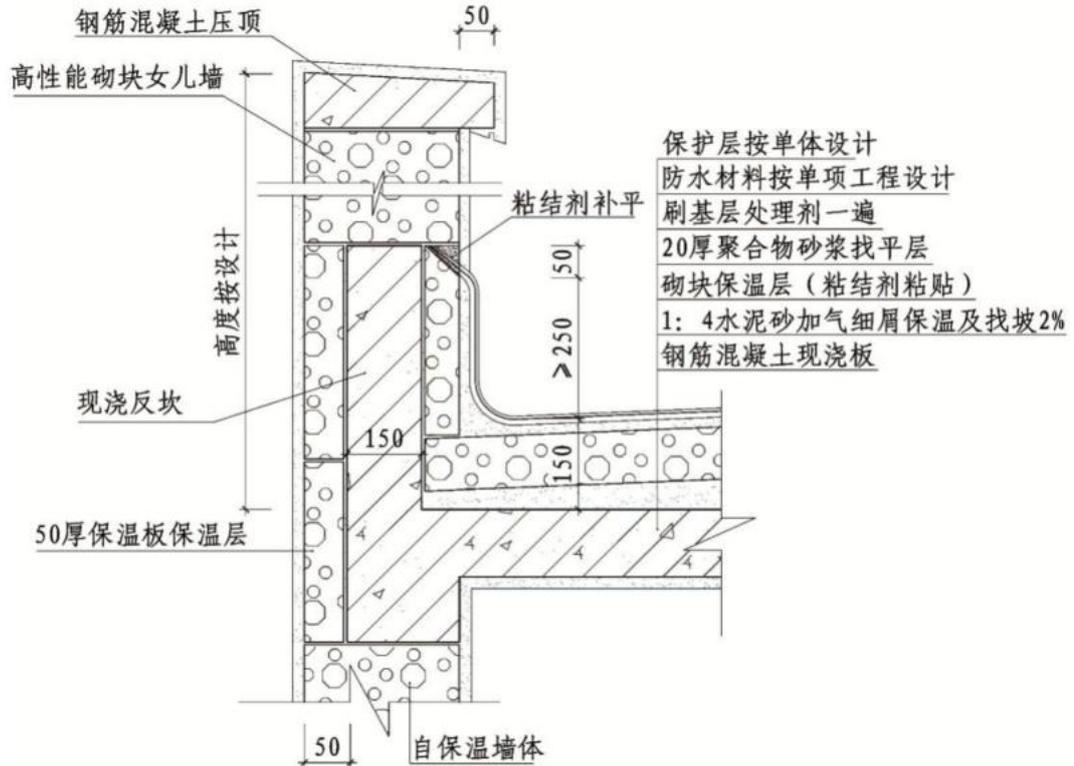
屋面保温防水构造 (上人屋面)
